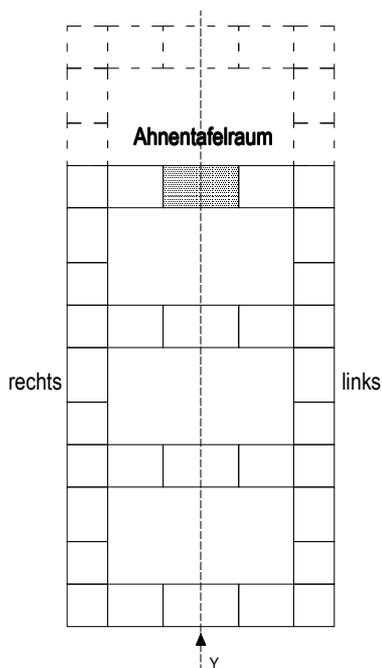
Grundriss- Schema des vertikal erweiterten Wohnhofs
